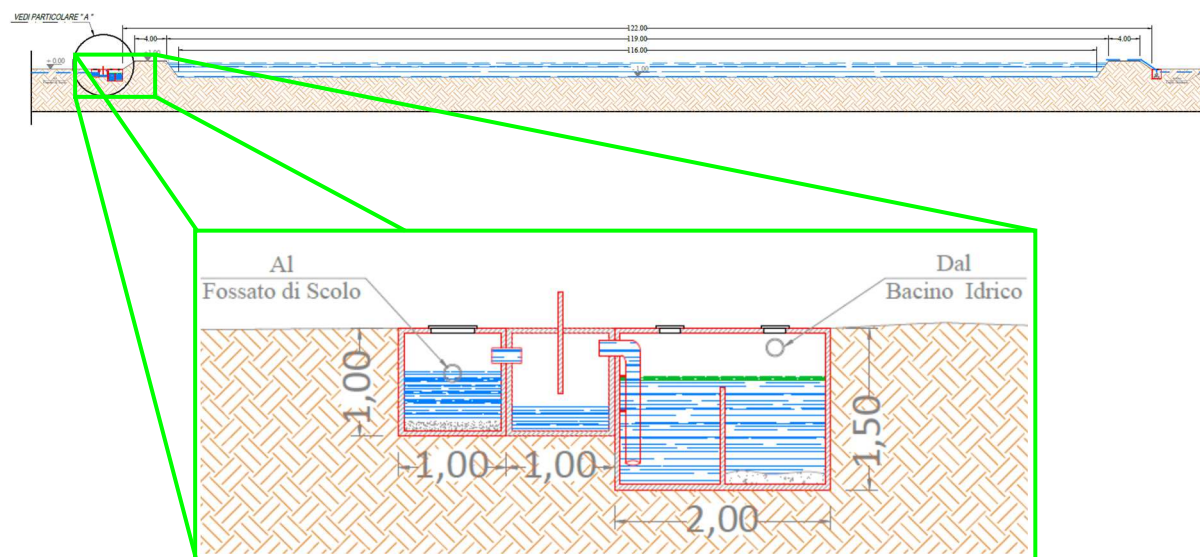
Estratto progettuale che illustra la sezione del bacino di laminazione, unitamente al dettaglio del pozzetto di raccolta delle delle acque meteoriche in uscita dal punto di stoccaggio
